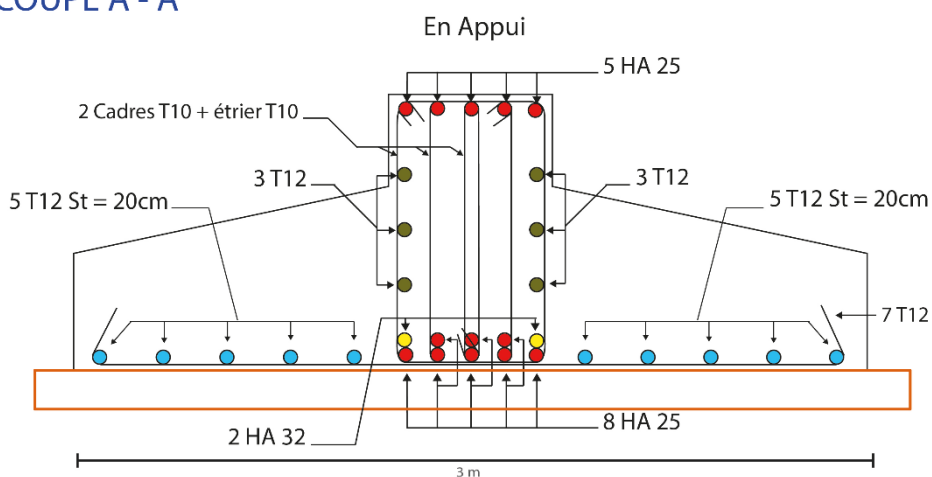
Schéma de ferrailage de la semelle filante en appui « coupe transversal A-A' ».
